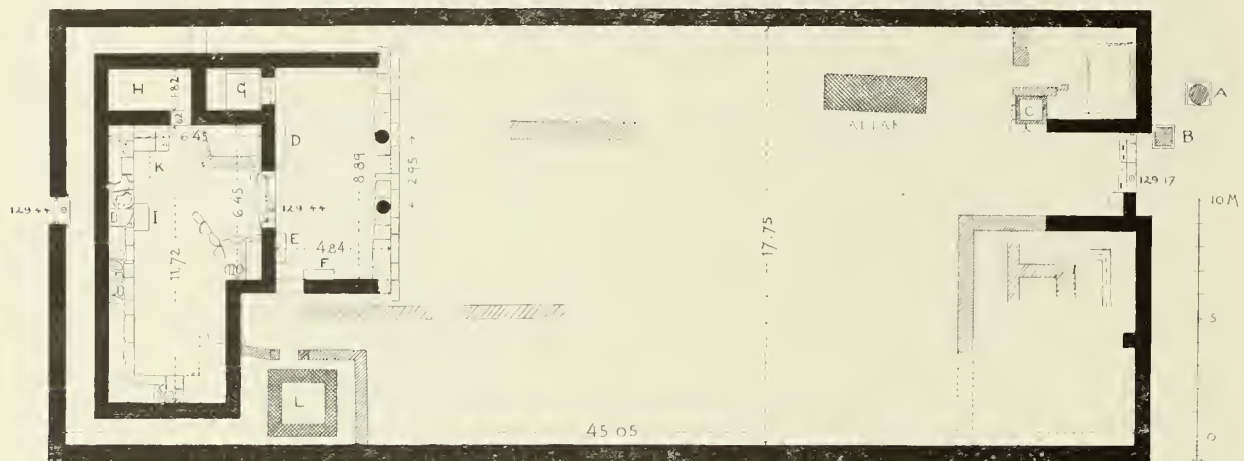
Grundriss des Demeter-Heiligtums.
